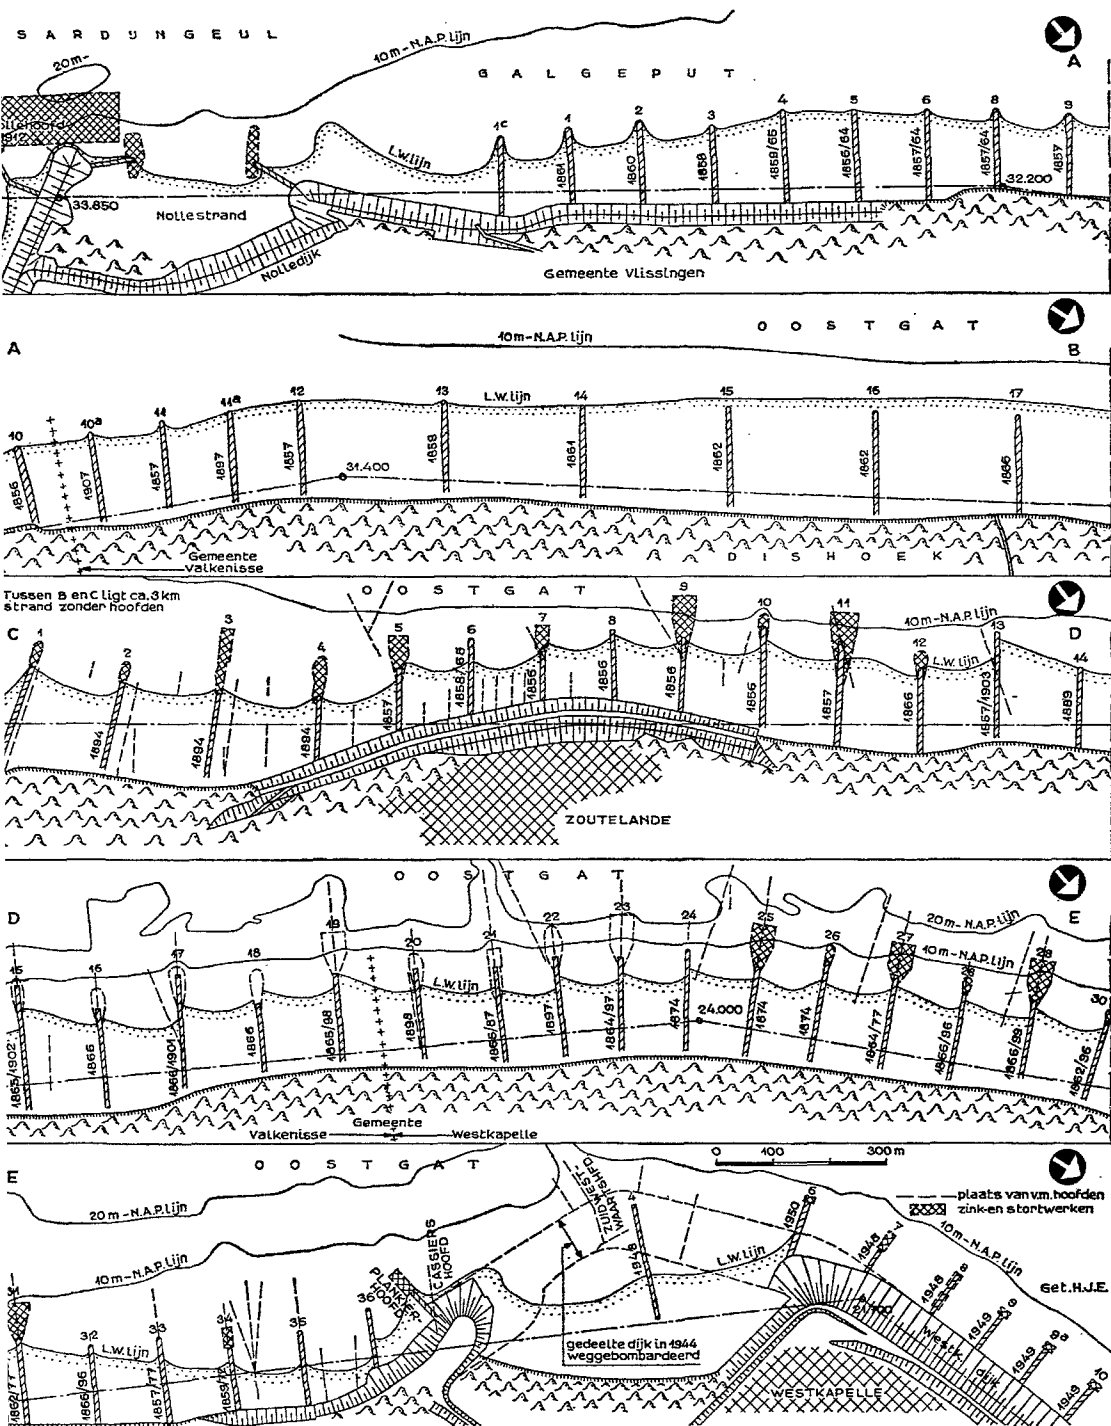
Overzicht van de strandhoofden tussen Vliissingen en Westkapelle. De plaatsen van de vervallen hoofden zijn met een - - - lijn aangegeven.
